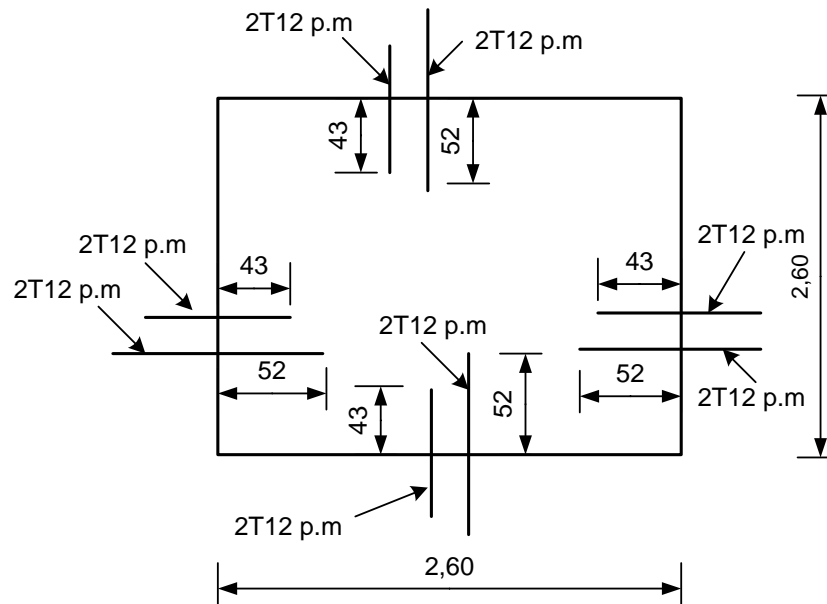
Ferrailage supérieur de la dalle de l'ascenseur (sur appuis).
